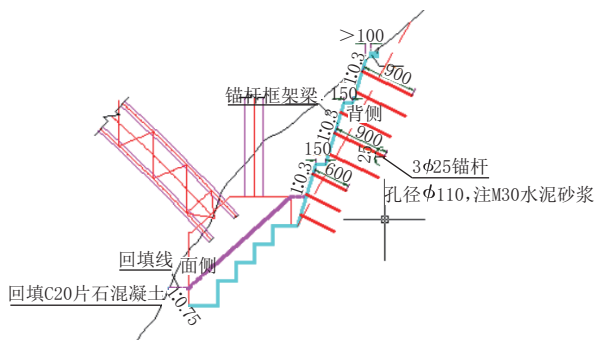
巫溪岸拱座基坑边坡加固设计剖面图
